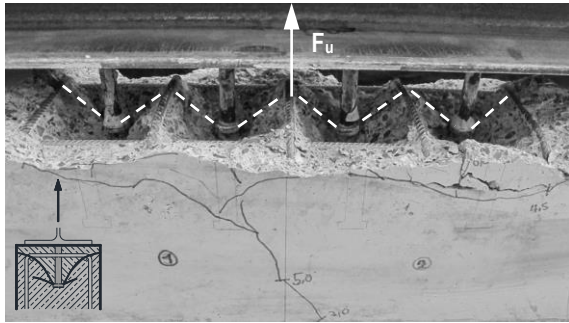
Betonausbruch zwischen der Bewehrung im Versuch R-01
